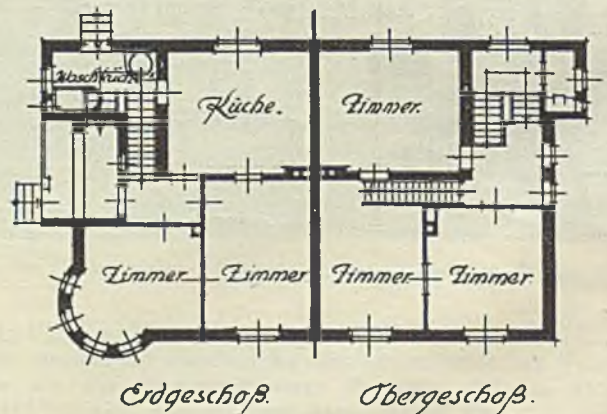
und 164. Landhaus Belthan in Buchschlag
